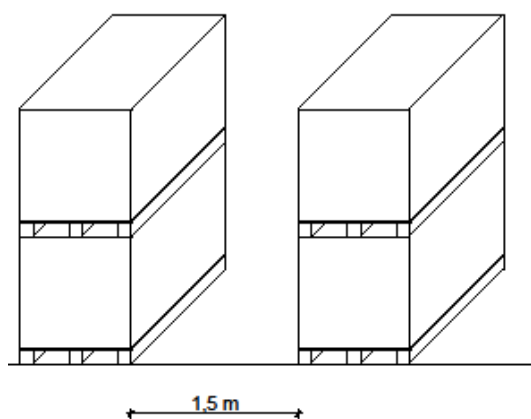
Skladování dřevěného materiálu – fošny, prkna
